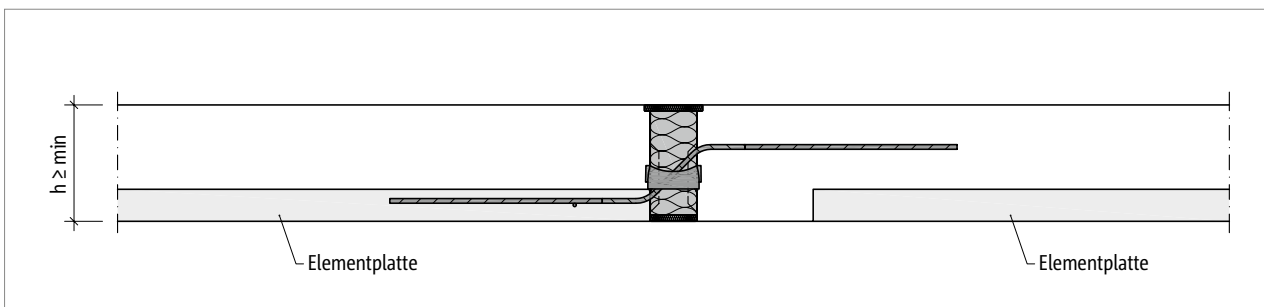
Schöck Isokorb® T Typ QL: Elementdecke mit eingesetzten Schöck Isokorb®
